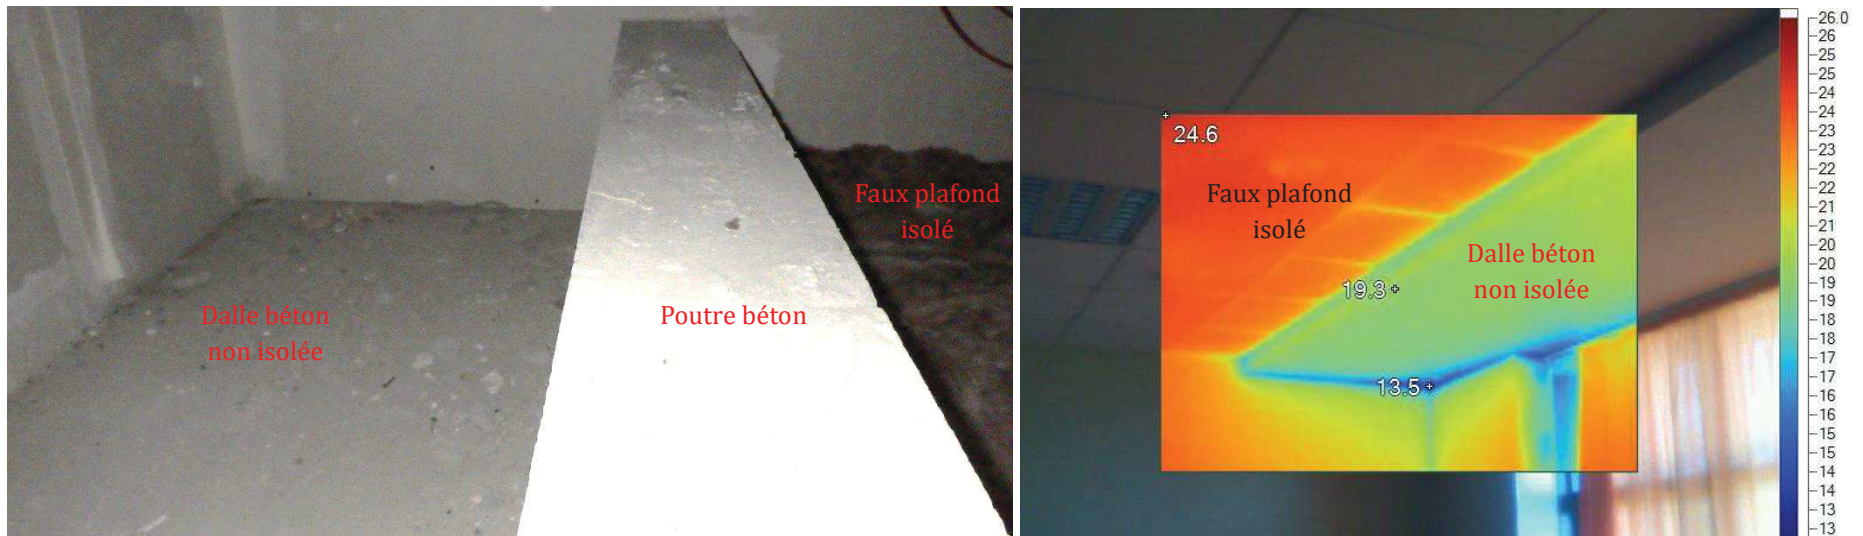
Primaire – dalle toiture terrasse non isolée en faux plafond – faiblement isolée par le dessus sans doute.
